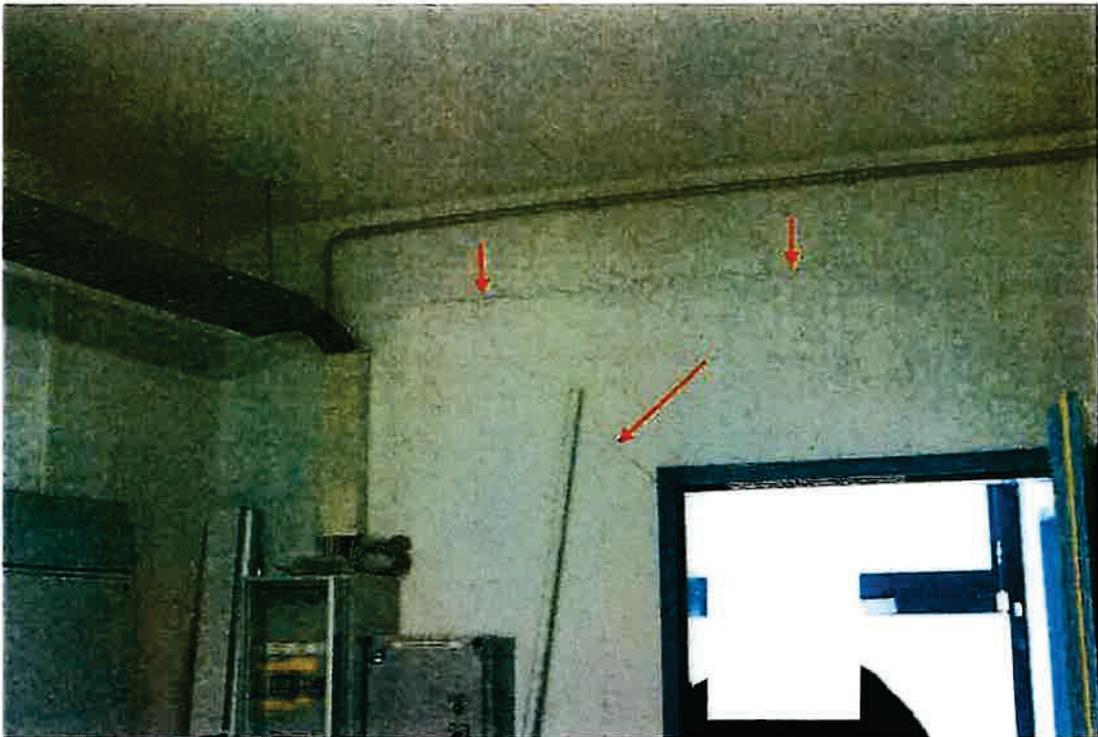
Heizung 2.2 Decke und Wand zum Gang
